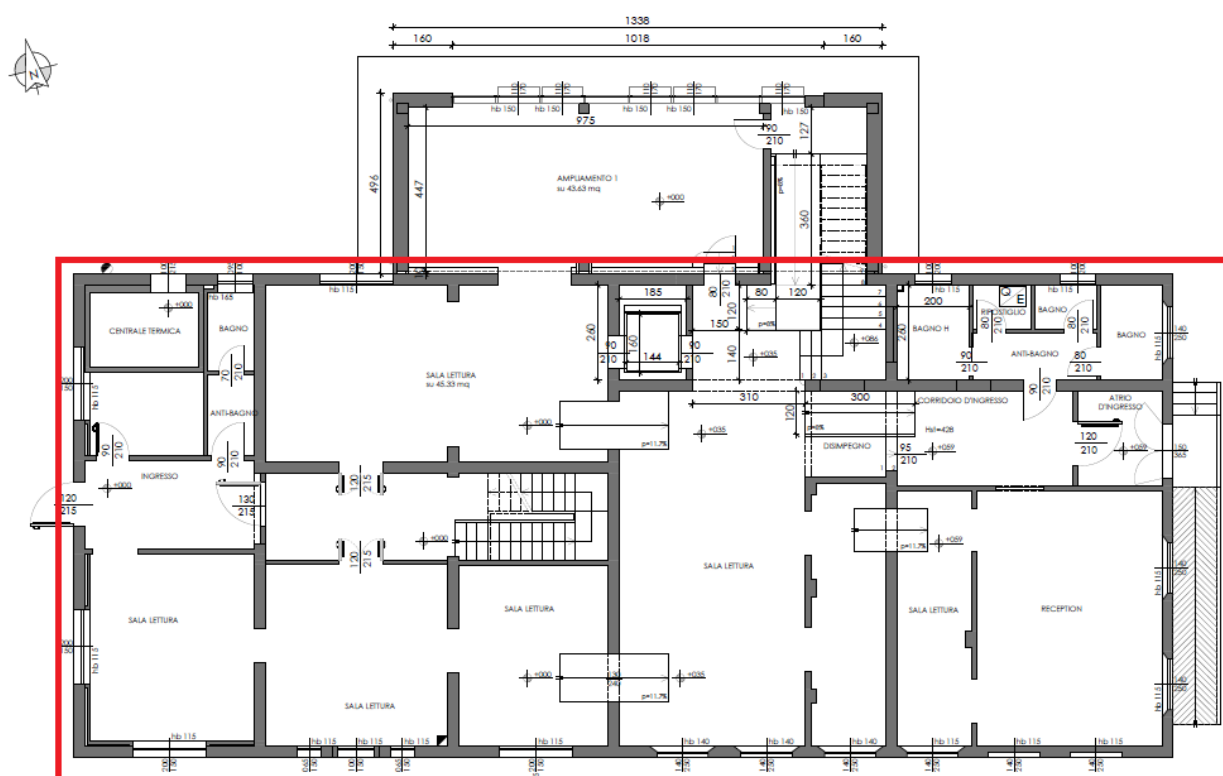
Planimetria generale dell'intervento - Individuazione edificio esistente
